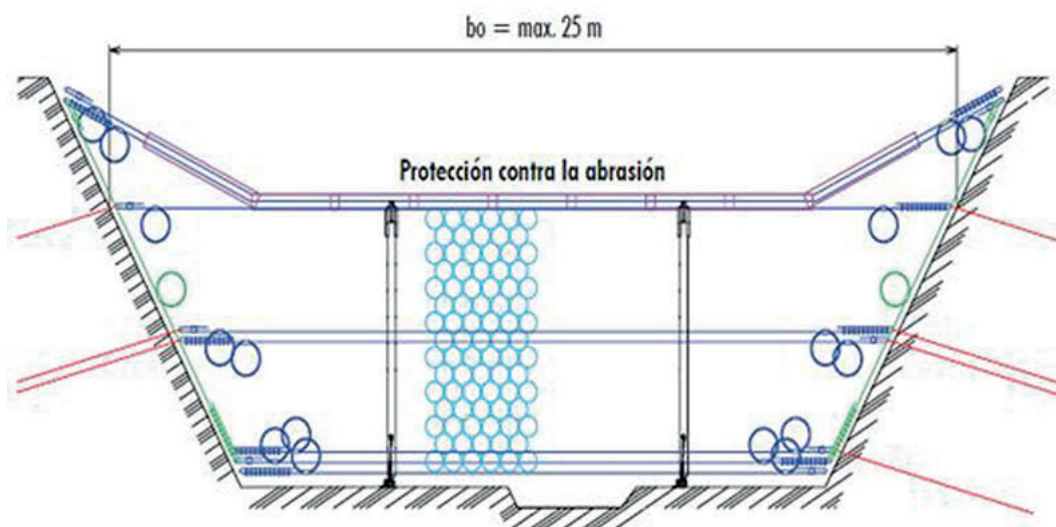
Barreras flexibles con ancho mayores que 15.00 metros lineales para quebradas anchas con forma de u somera.
